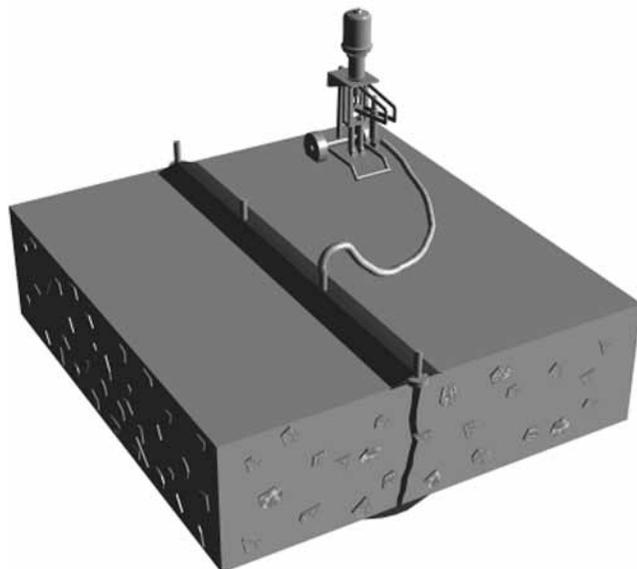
Inicio la inyección en el segmento más ancho de la grieta.
